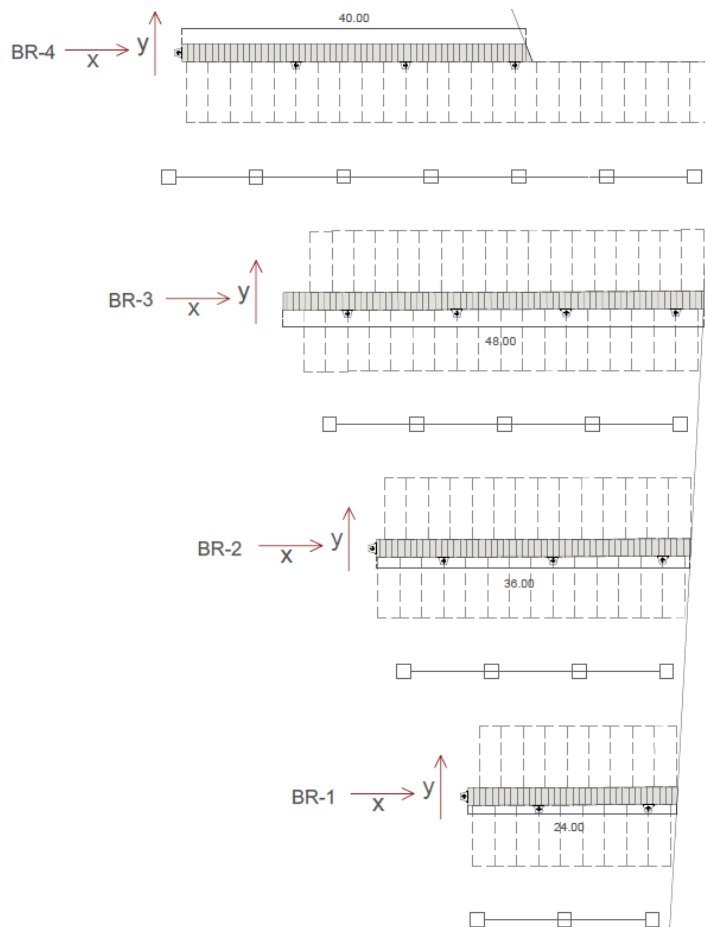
Stralcio planimetrico pontili galleggianti per scopi sociali - barche da 6 m
